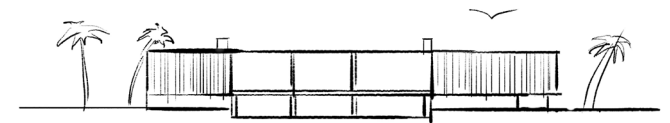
Boceto de un alzado de la Resor House en un contexto costero
